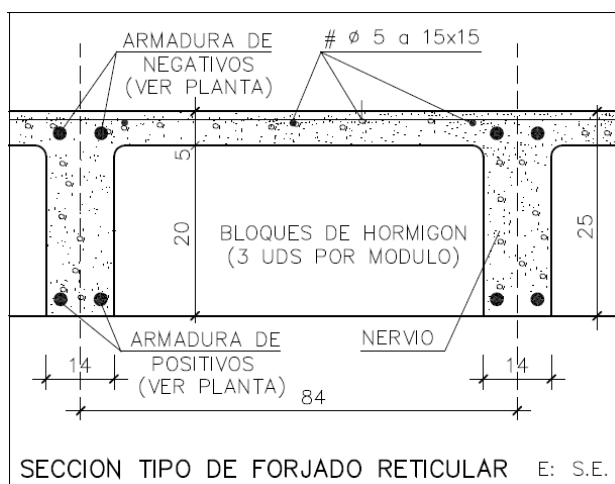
Detalle de forjado reticular. <https://www.campobaeza.com/es/sports-pavilion-university/>.
